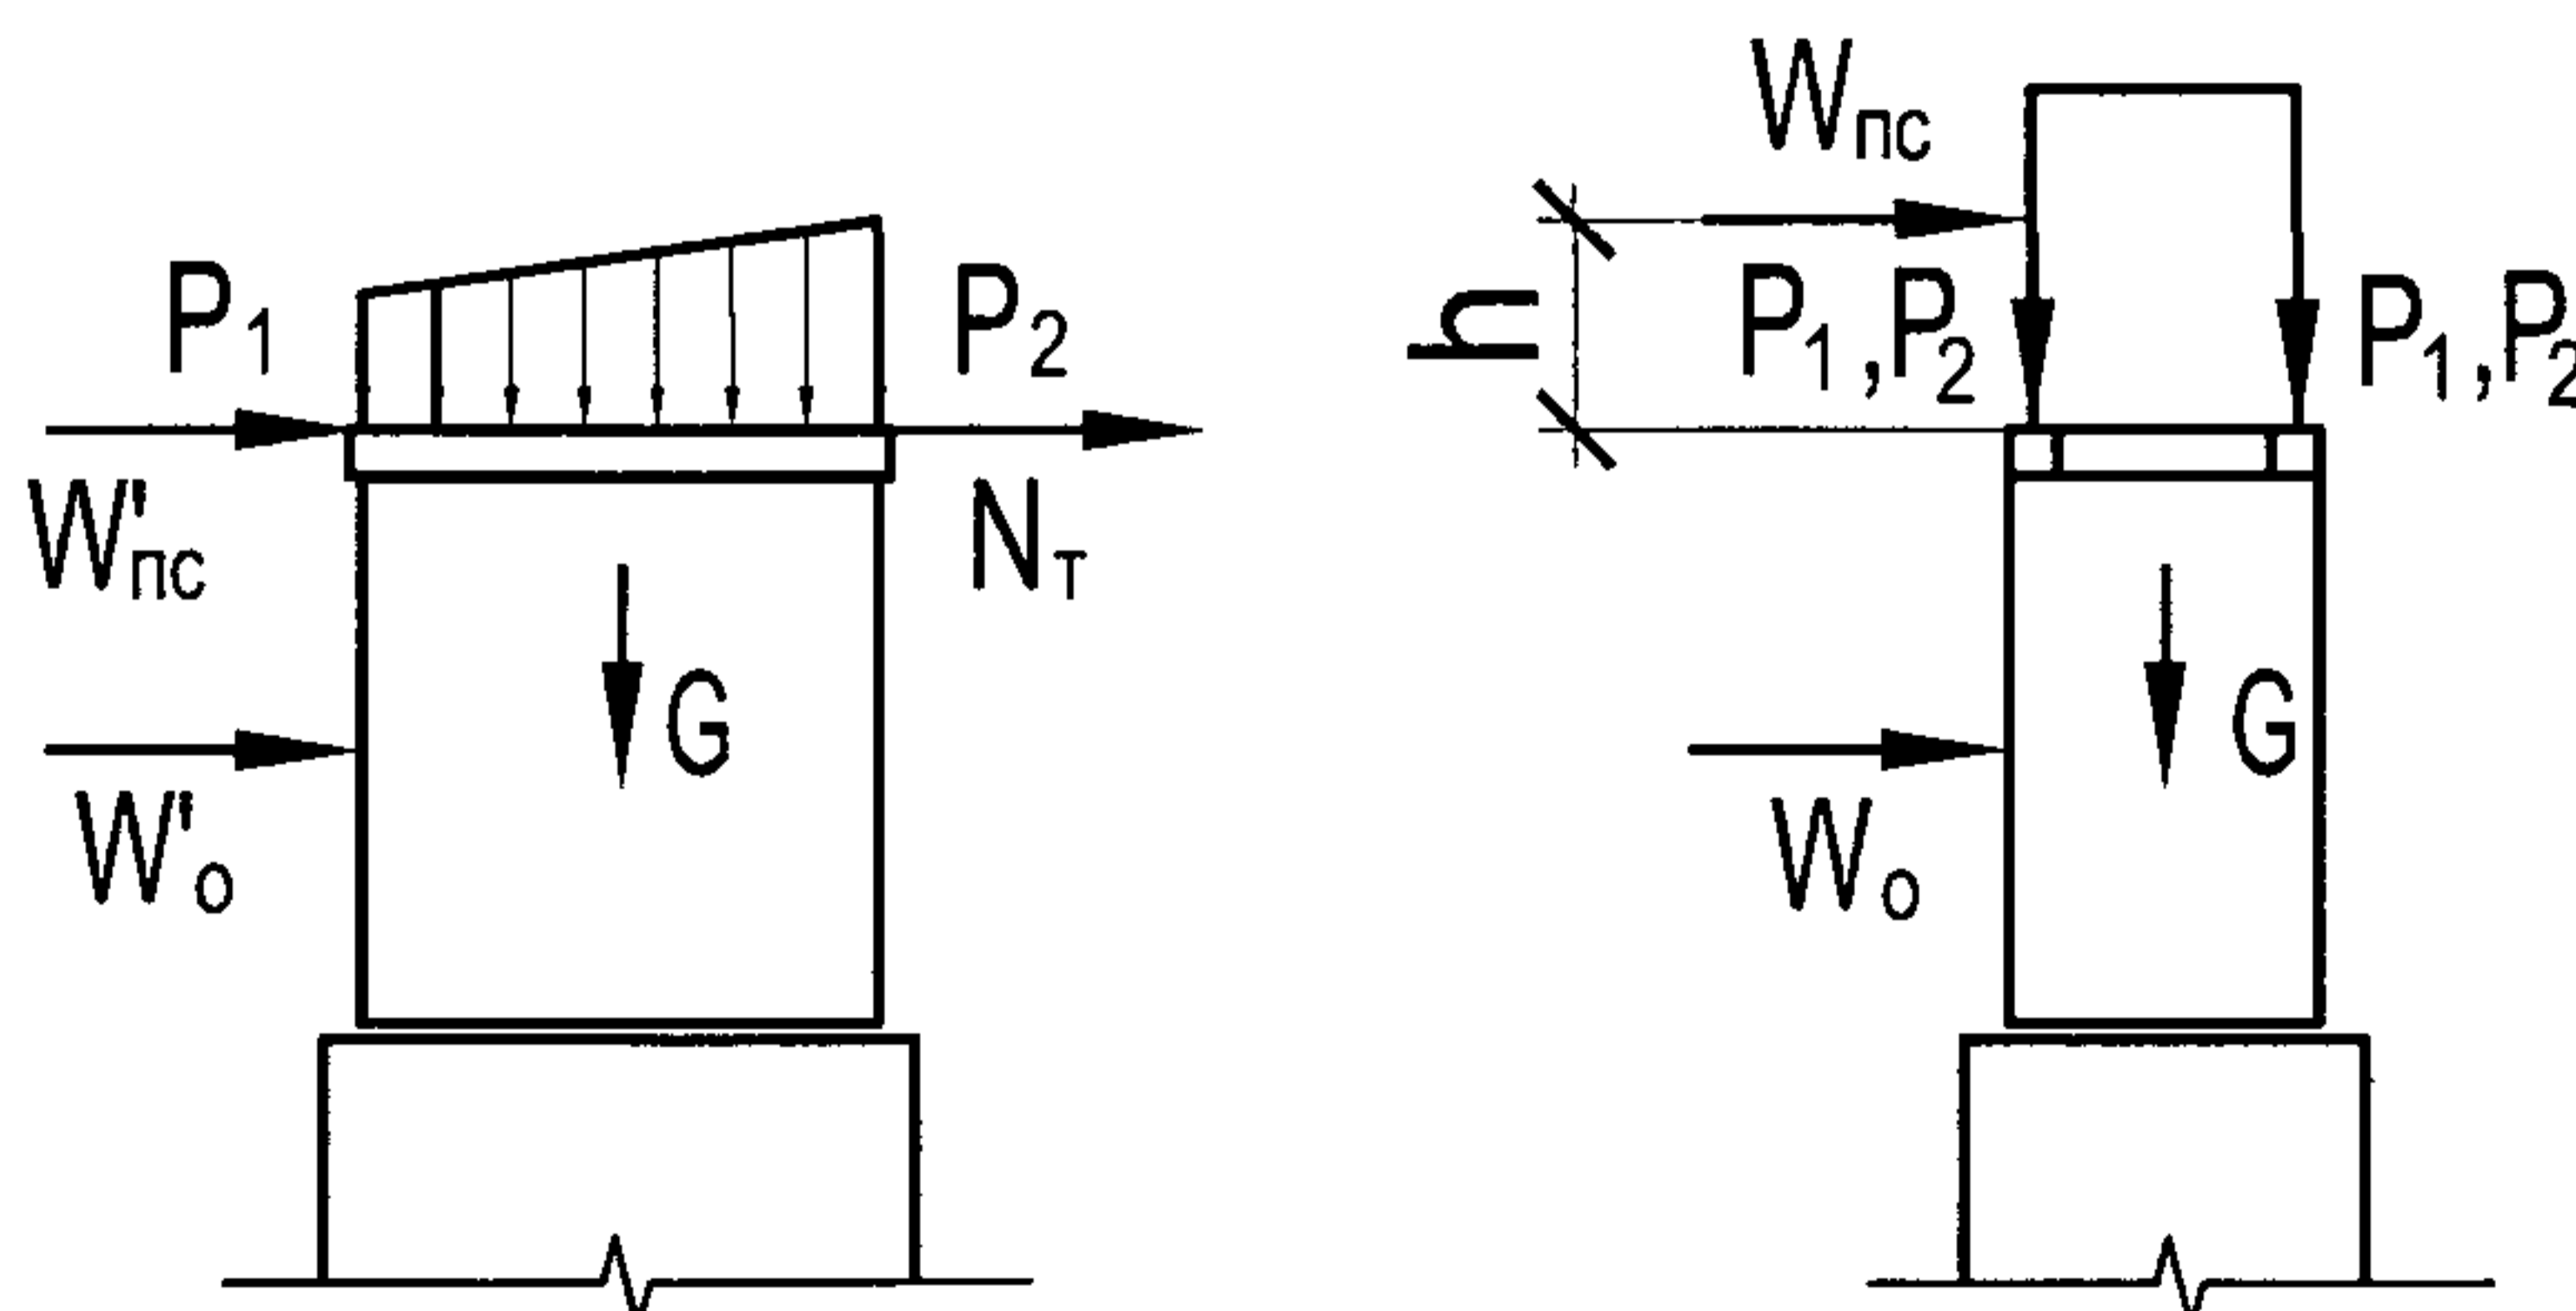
Схема приложения нагрузок к перекаточной опоре.
